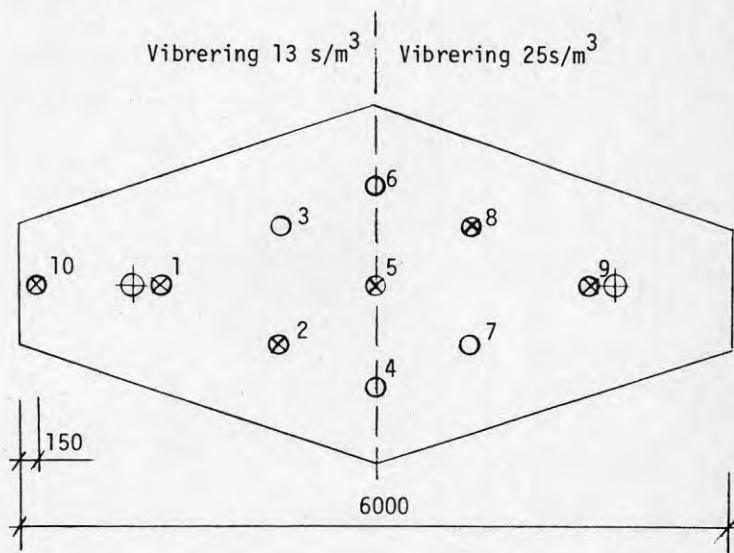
Monolit nr 7. Pejlade betongnivåer i centrumlinjen.
